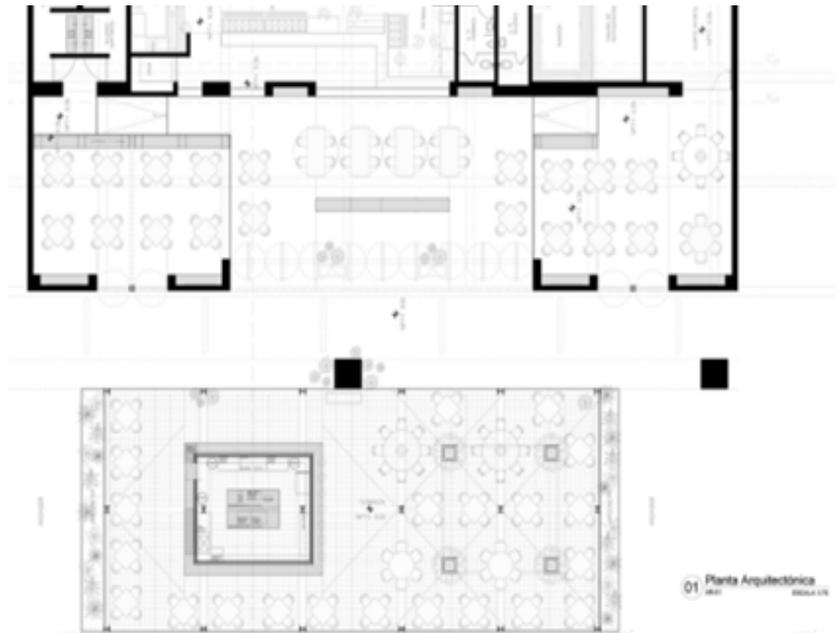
Planta arquitectónica, fuente:<http://www.archdaily.mx/mx/880321/restaurante-la-tequila-leon-inaki-diaz-de-leon-orraca>, fecha: [06-10-2017]
